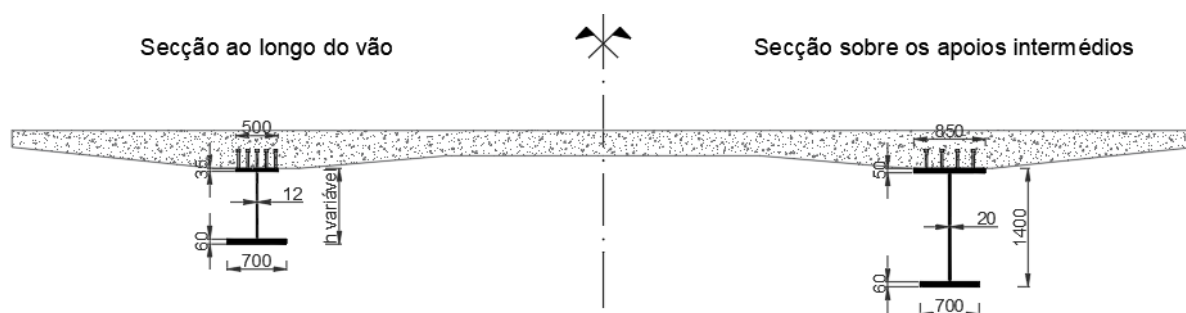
Secção transversal típica das vigas metálicas (dimensões em milímetros)
